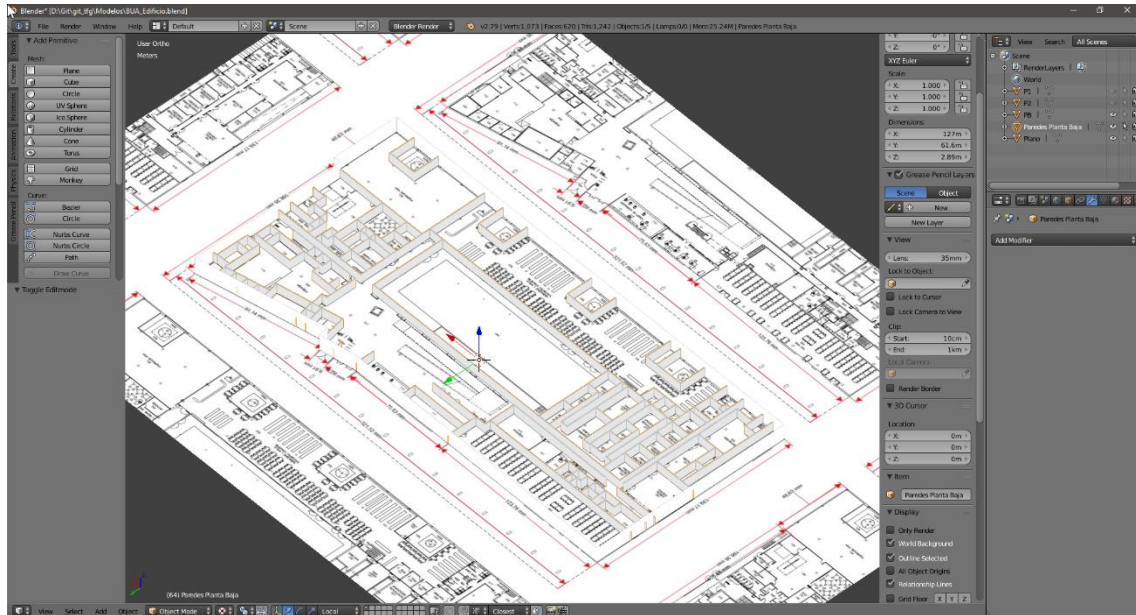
Inserción de paredes en la planta baja de la BUA
